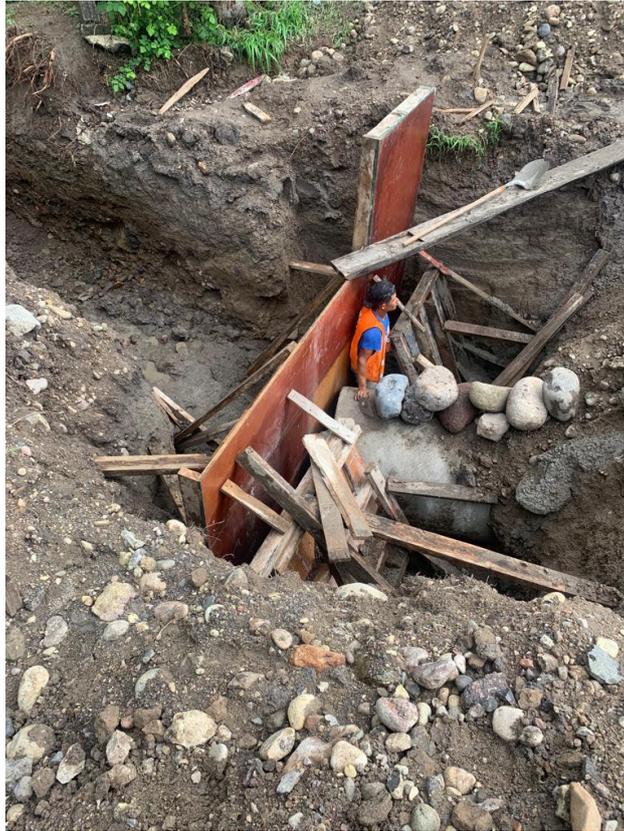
Encofrado de cabezal de alcantarilla de salida estación 30+408
